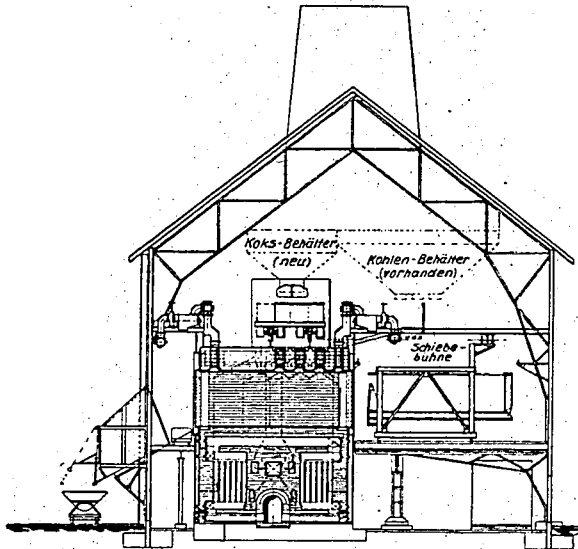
Horizontalalkammerofen in ein bestehendes Ofenhaus eingebaut.
